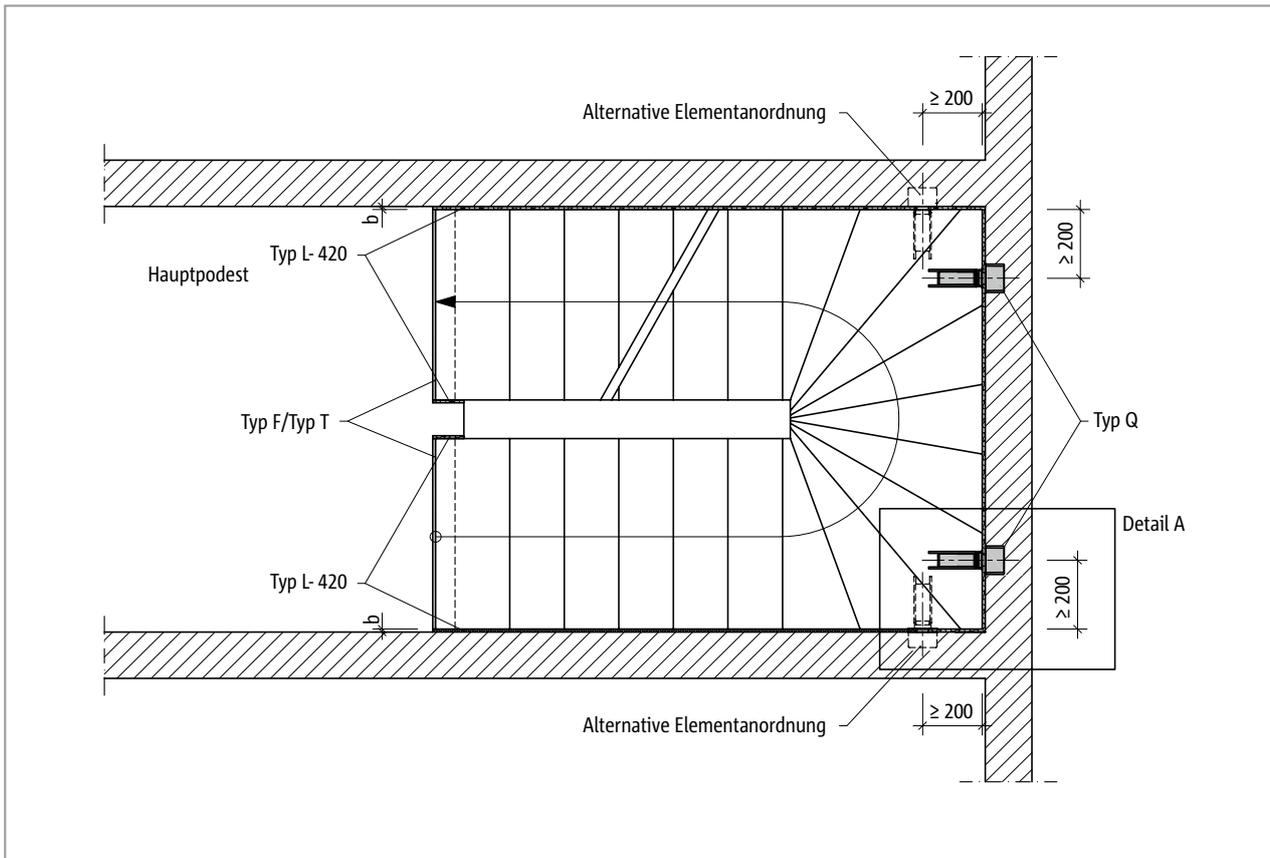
Schöck Tronsole® Typ Q: Elementanordnung im Grundriss mit Verwendung der Tronsole® Typ L
